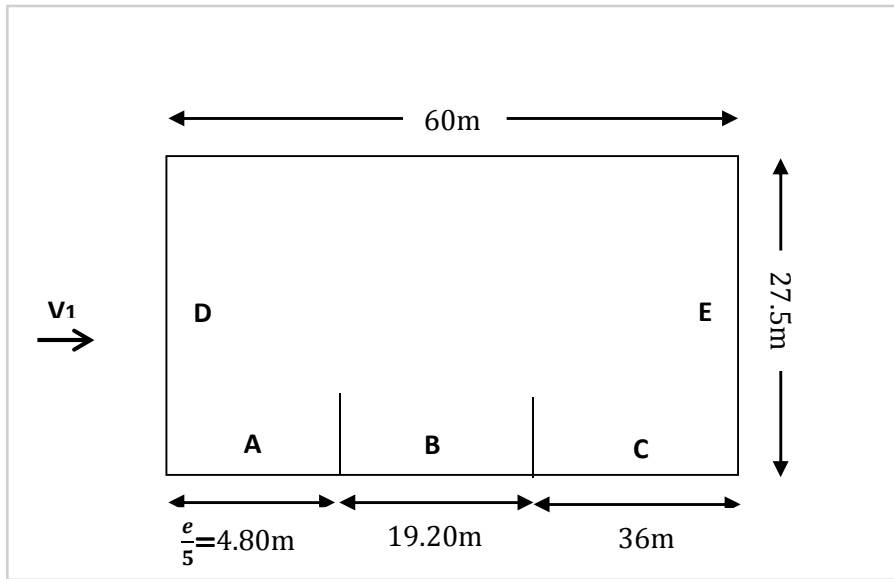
vue en plan des zones de pression sur les parois verticales sens V1.
